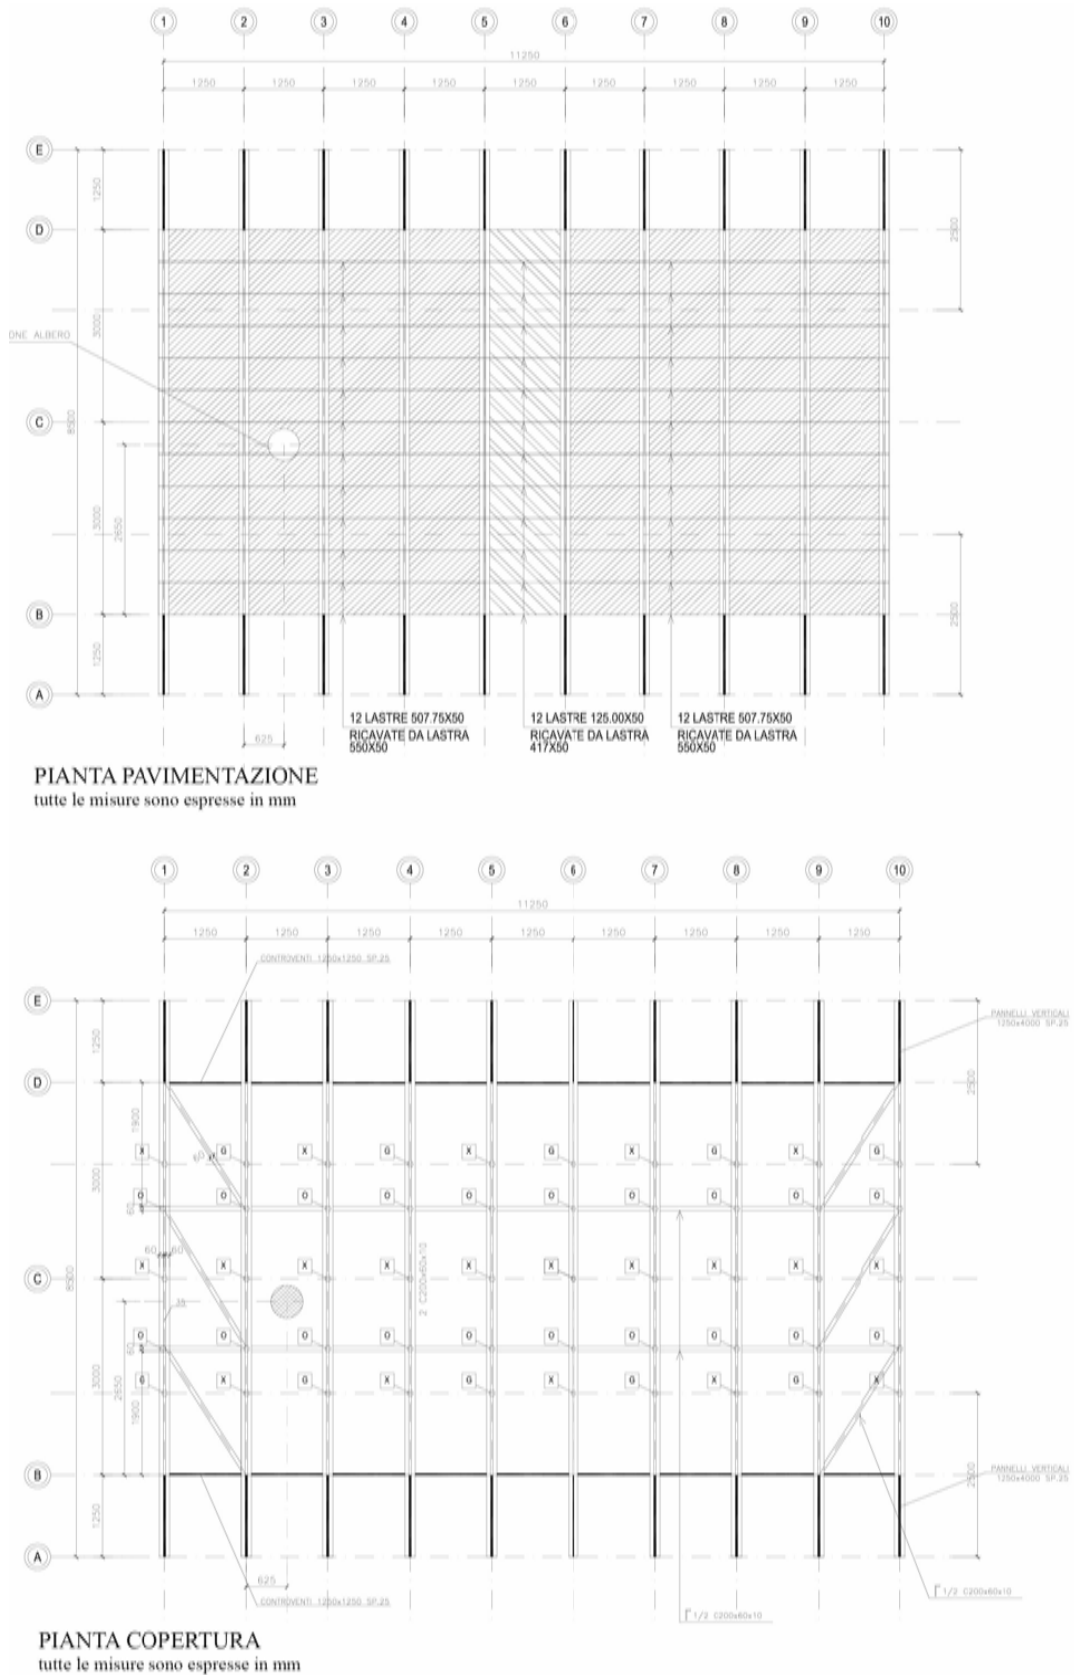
Planimetria pavimentazione e coperture della Glass House.
